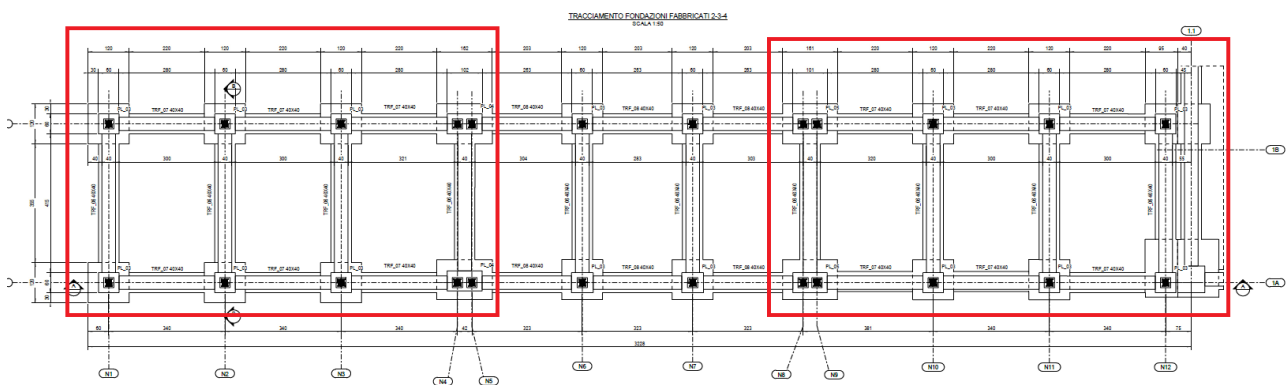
Ex Galoppatoio – pianta delle fondazioni Fabbricato 2-4
